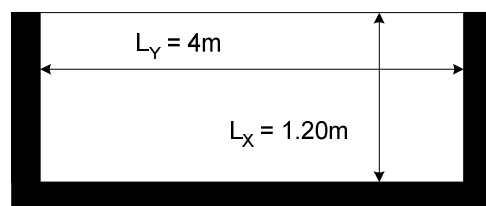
Schéma d'une dalle sur trois appuis (Type2)
